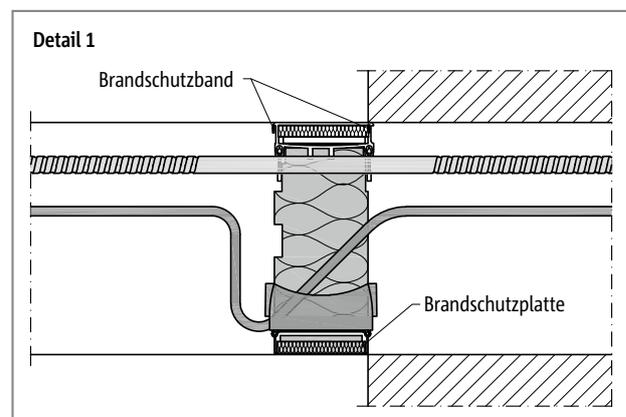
Schöck Isokorb® CT Typ KL bei REI 120: Detail 1
